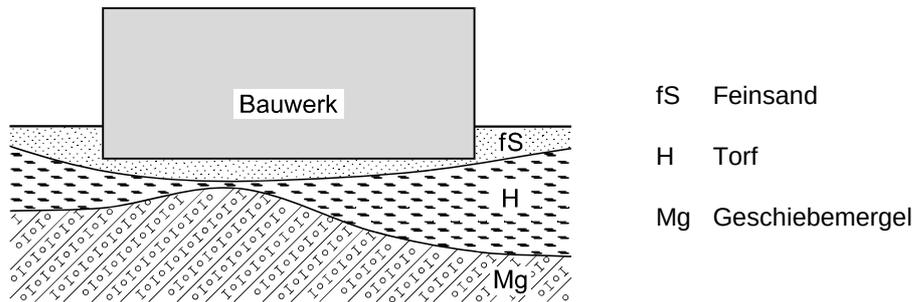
Baugrund unter einem geplanten Bauwerk
